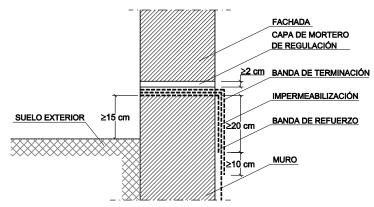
Ejemplo de encuentro de un muro impermeabilizado por el interior con lámina con una fachada
